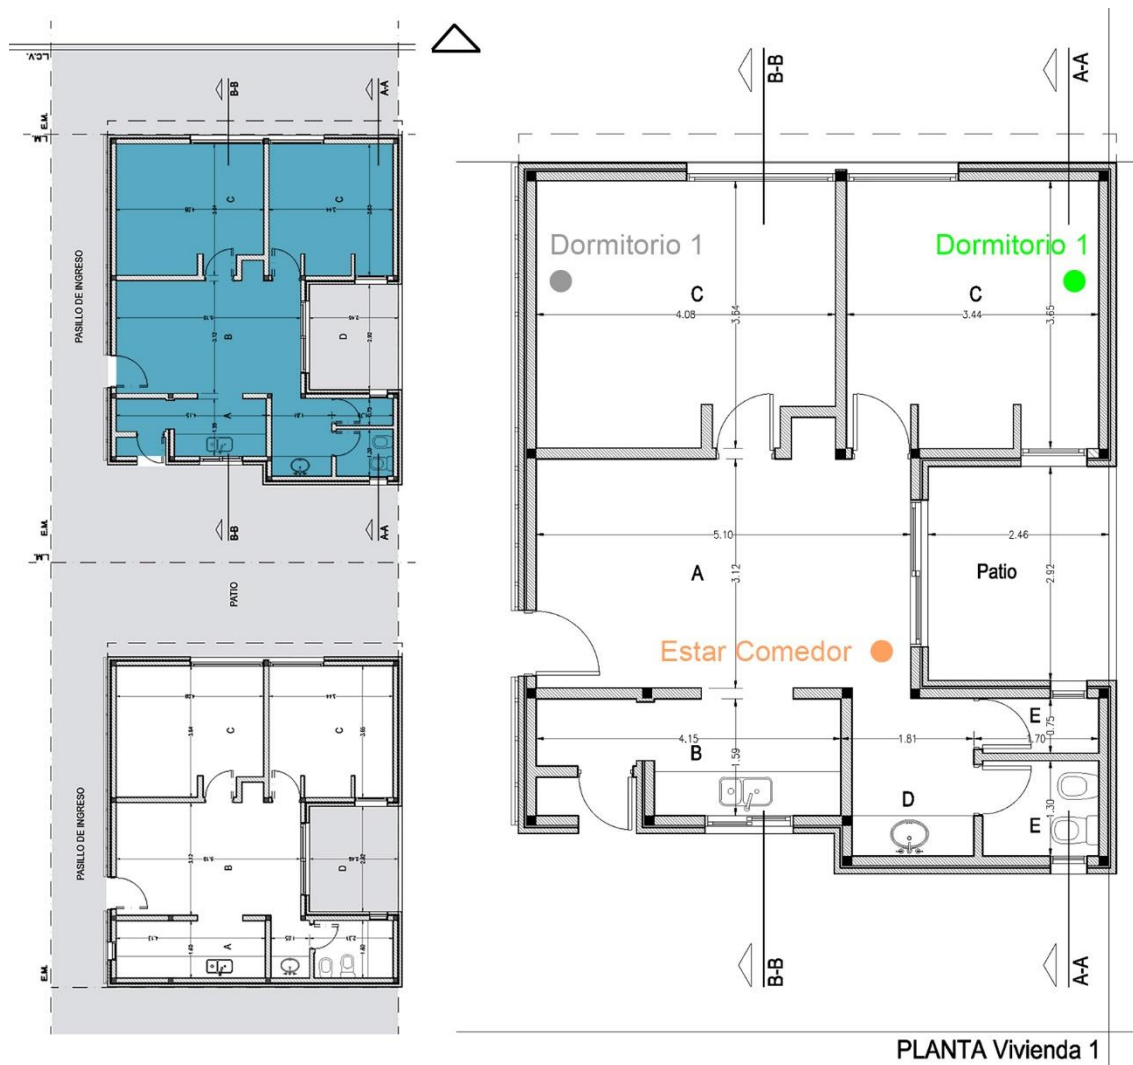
conjunto 2V: a. Planimetría del conjunto; b. planta conjunto.
